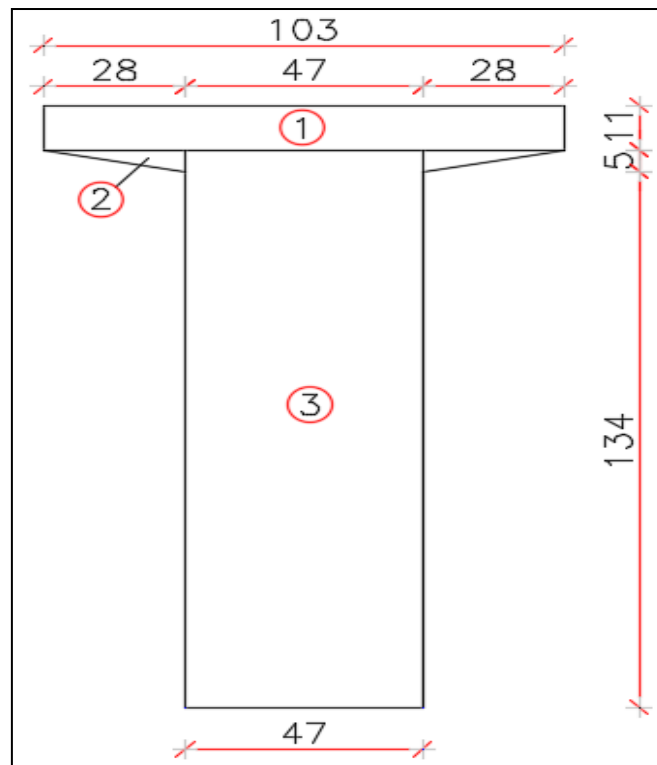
Section d'about de la poutre d'about sans hourdis.
